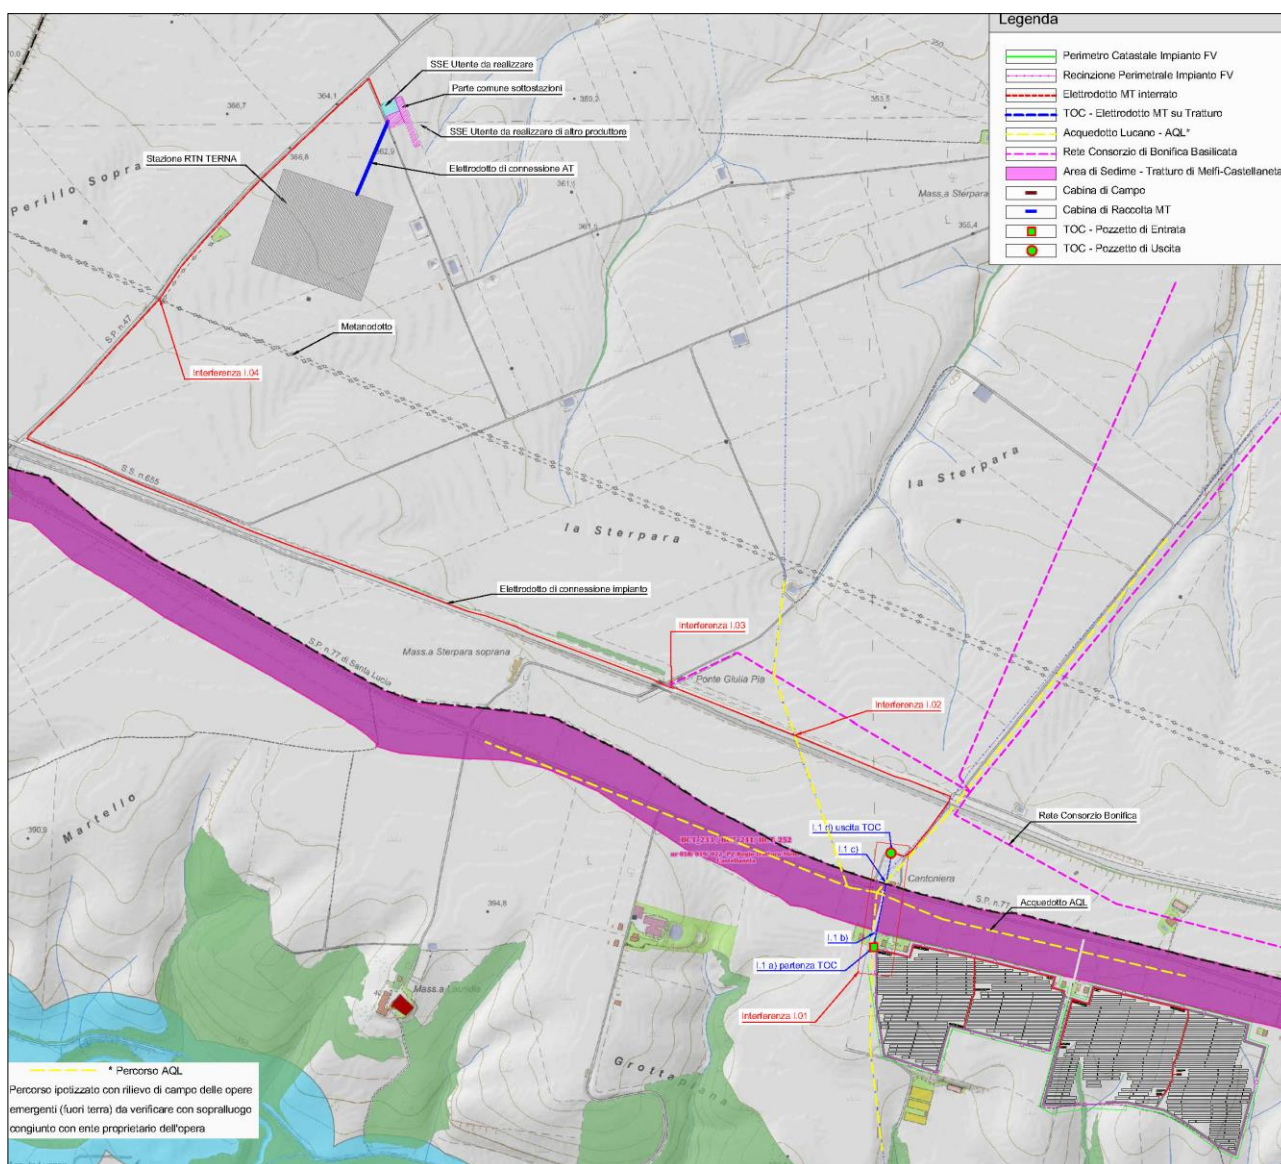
Planimetria interferenze con opere idrauliche rilevate lungo il tracciato
